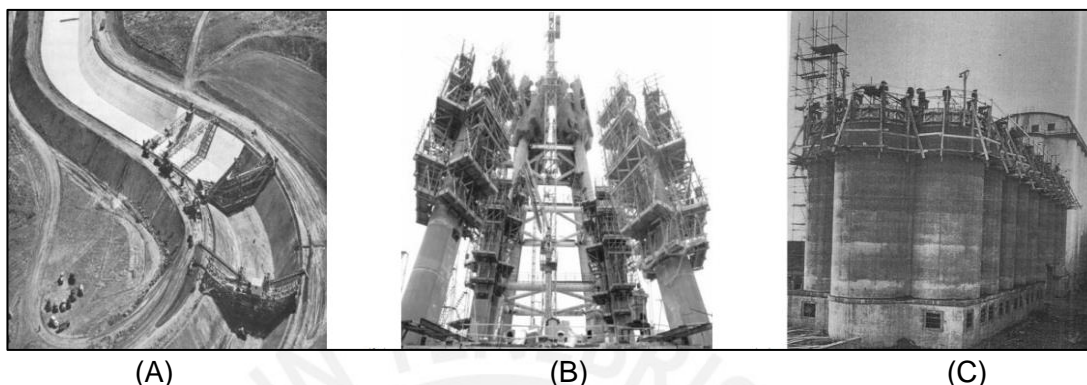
13 (A) Sistema Encofrado Autotrepante Horizontal. (B) Sistema Encofrado Autotrepante Inclinado. (C) Sistema de Encofrado Autotrepante Vertical (Ramesh Kannan. M, 2013)
